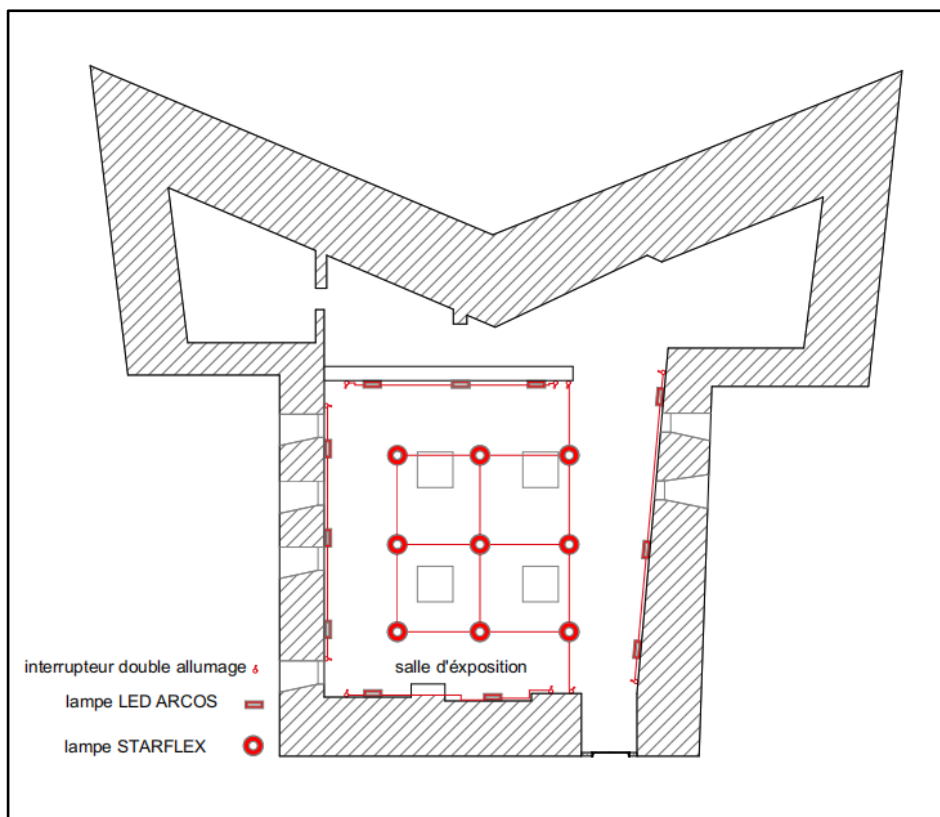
Plan d'éclairage artificiel proposer pour le musée bordj moussa
